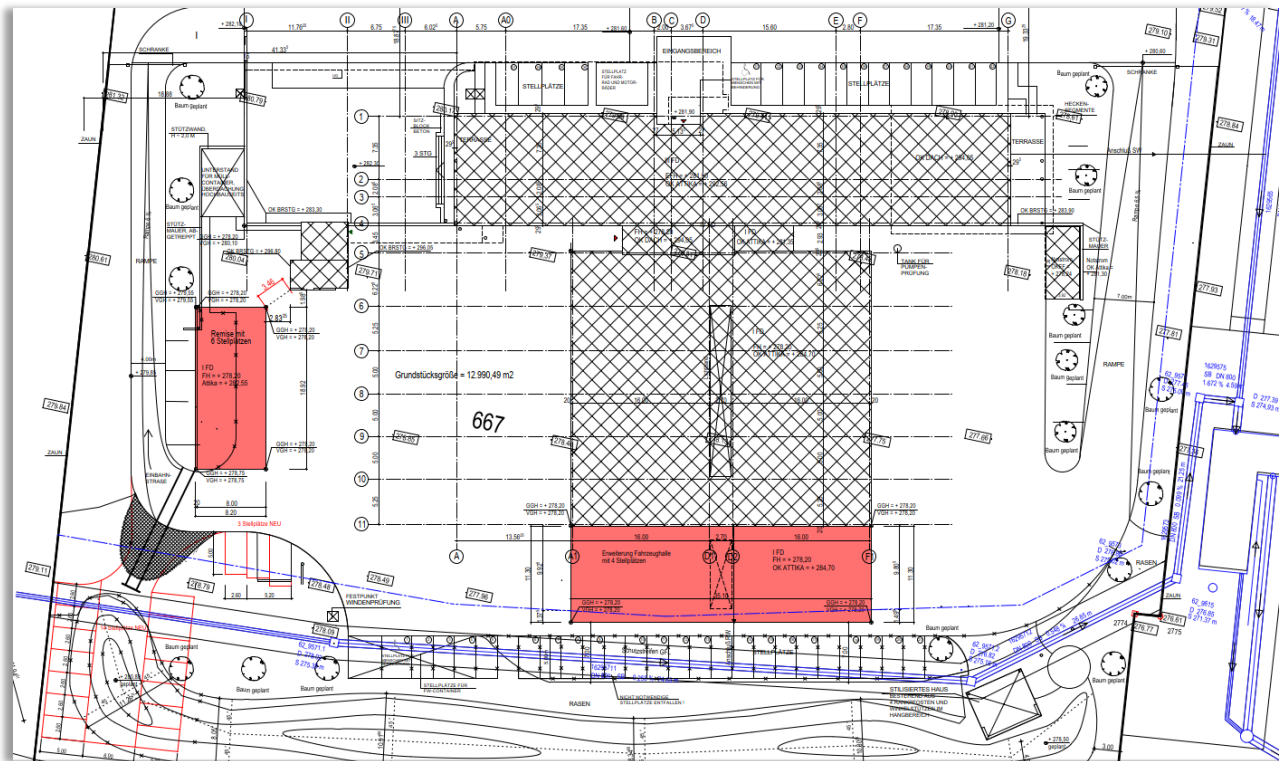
Lageplan aus Bauantragsunterlagen vom 04.02.2025
